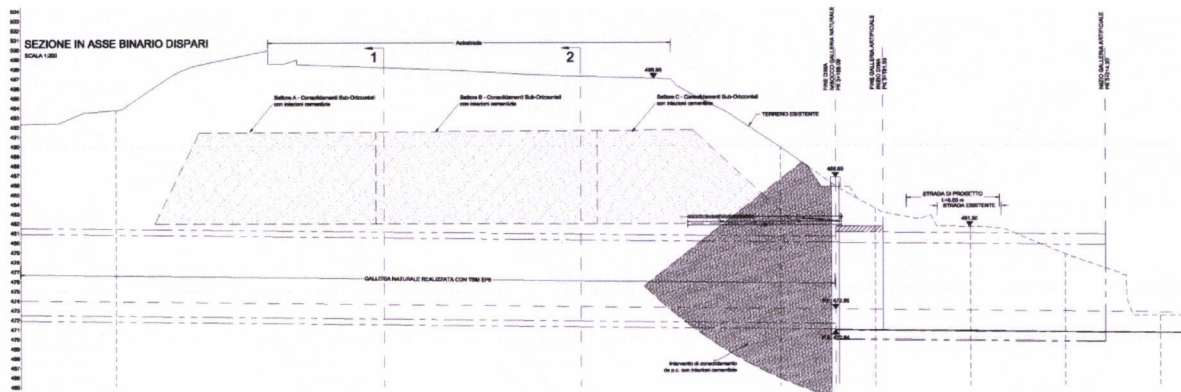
Sezione longitudinale interventi sotto il rilevato autostradale e nella zona dell'imbocco della galleria
